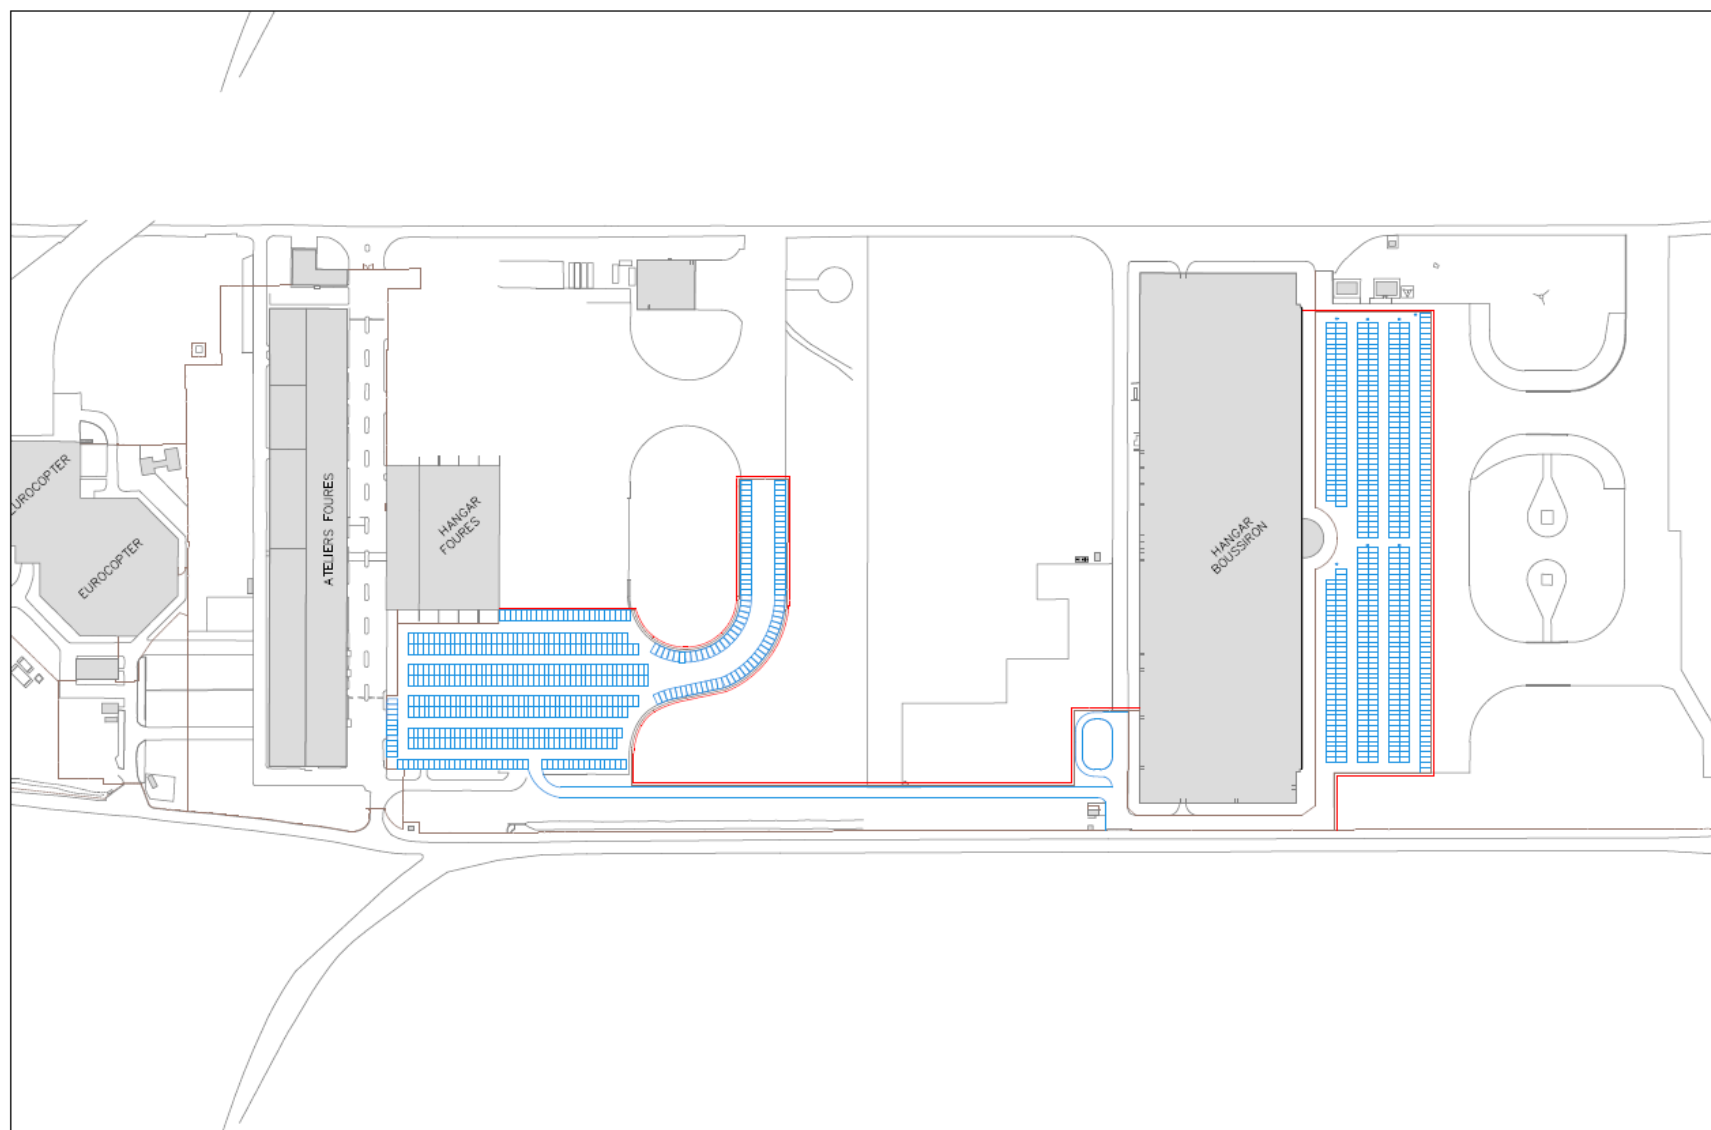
Plan des parkings Foures et Boussiron (source : AMP)
